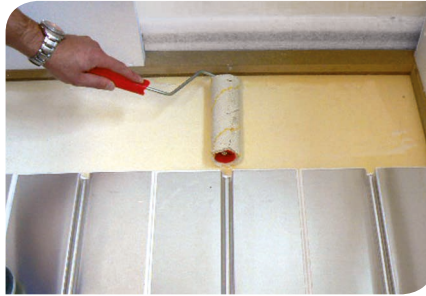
Bei leichten Konstruktionen (z.B. Parkett Direktauflage) Elemente vollflächig verkleben
